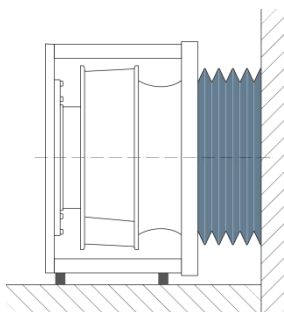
Вид сбоку вентилятора RadiPac кубической конструкции с гибкой вставкой на стороне впуска
